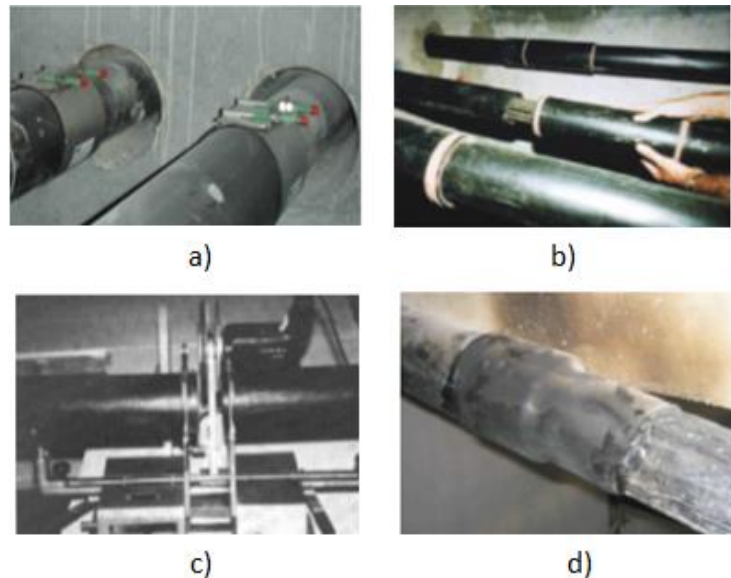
a) abraçadeira mecânica; b) manga de polietileno; c) soldadura topo-a-topo; d) união termoretrátil (PRETO, 2014)
